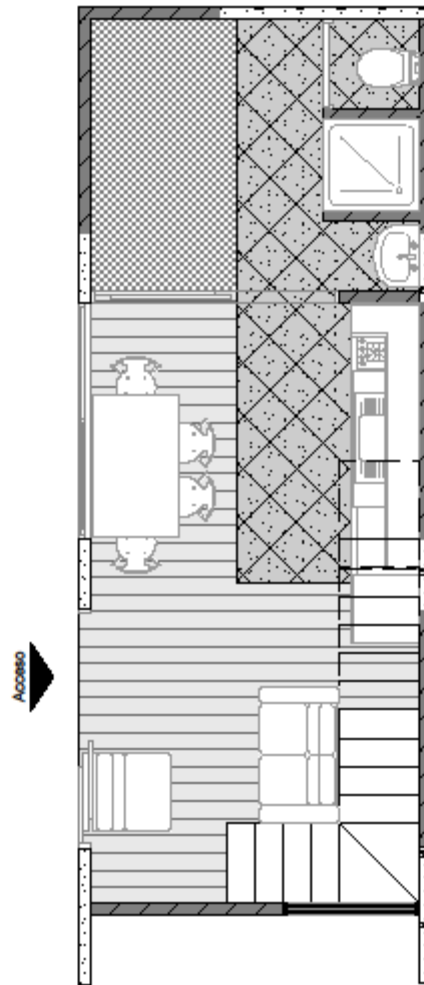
Tipo C. Plano Primer Piso Amoblado. Esc.: 1:50.
